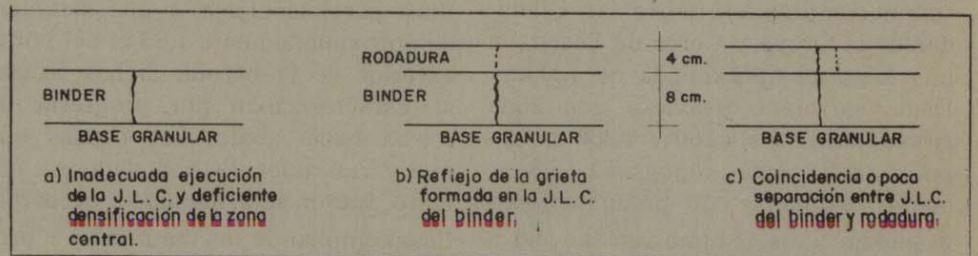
POSIBLES CAUSAS DE LA APARICION DE FISURAS A LO LARGO DE LA JUNTA LONGITUDINAL DE CONSTRUCCION.
